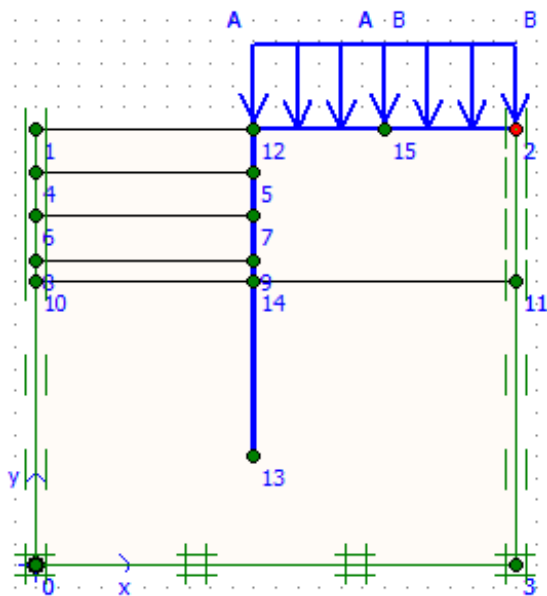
Esquema de la geometría del muro B y sus cargas
